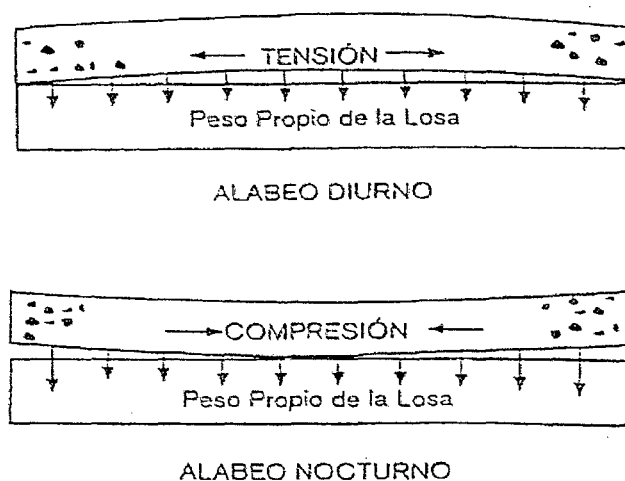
1 Alabeo de las losas de los pavimentos de concreto.
